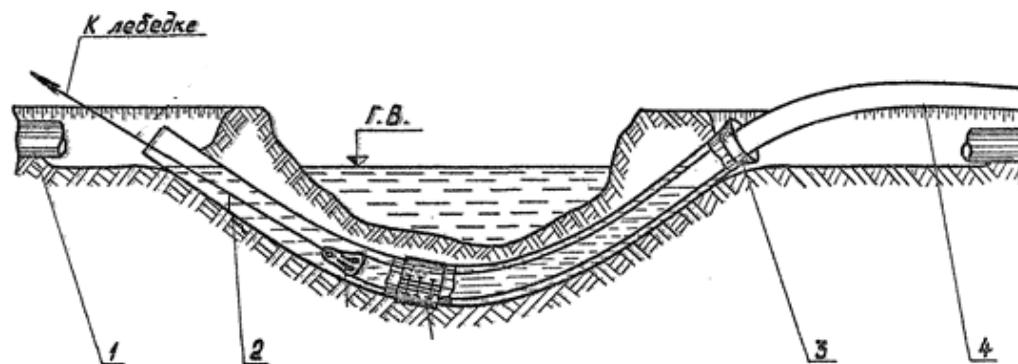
Укладка трубопровода по схеме «труба в трубе»:
